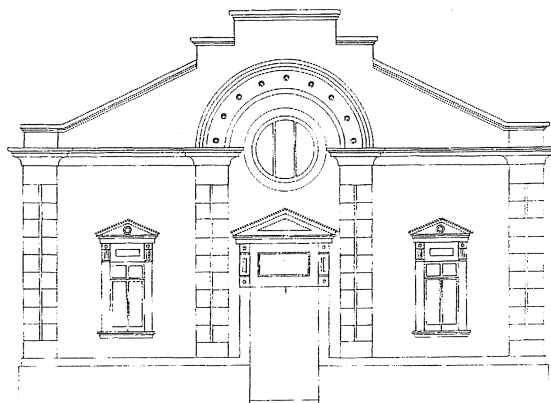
ALZADO POSTERIOR DEL PROYECTO.
